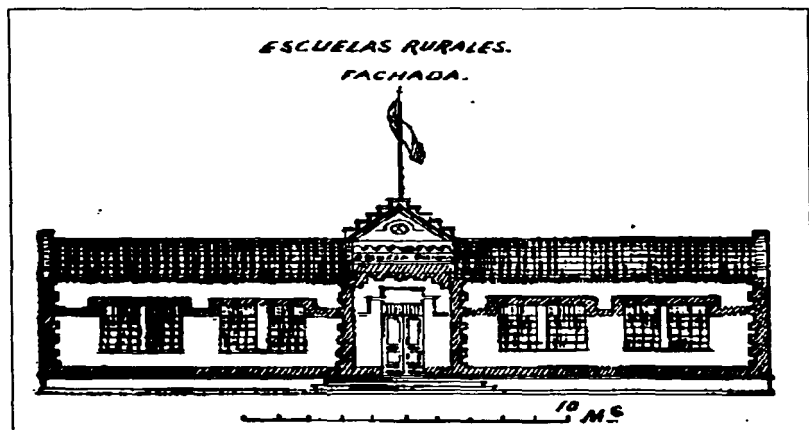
(03) Escuela rural. Fachada genérica del aula casa rural.
